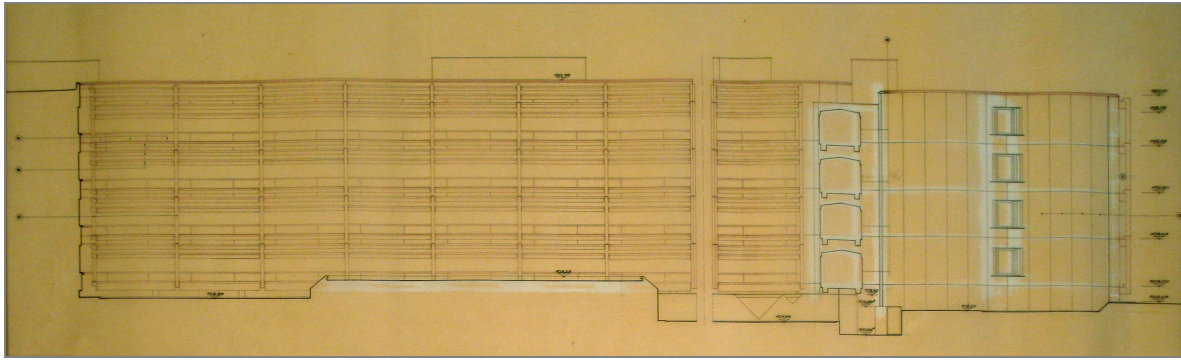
prospetto interno A (fonte CSAC – stralcio tav. 56, archivio n. 384-6)
